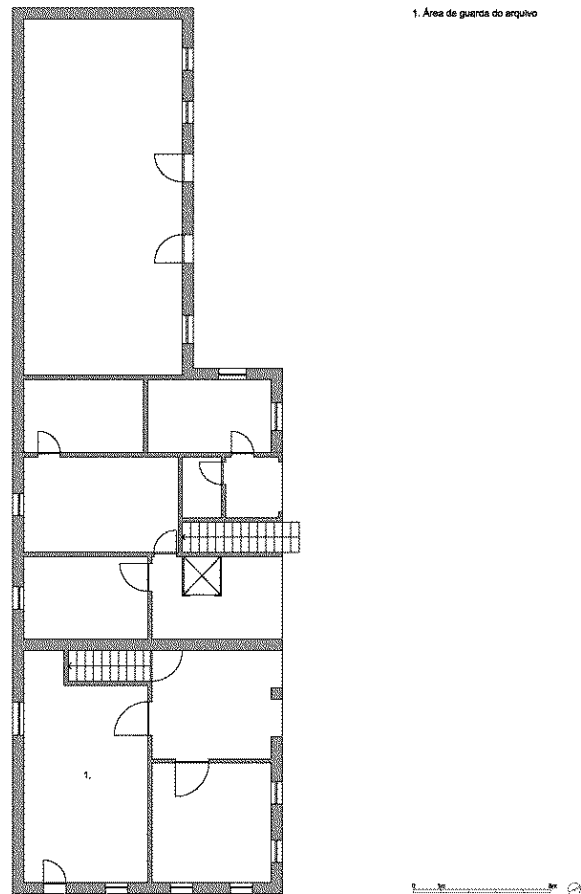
Planta baixa do pavimento inferior indicando a área de guarda onde estava armazenado o acervo durante a gestão de Vicente Vale (1998-2008).
